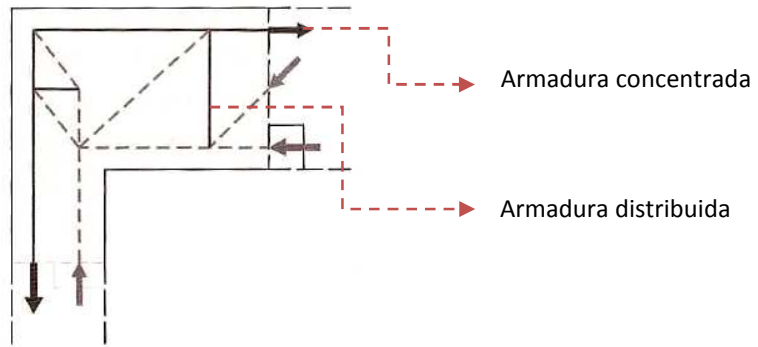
Modelo de bielas y tirantes para el encuentro de una viga y pilar de última planta de un pórtico, cuando el canto del pilar es menor que el de la viga.[1]
